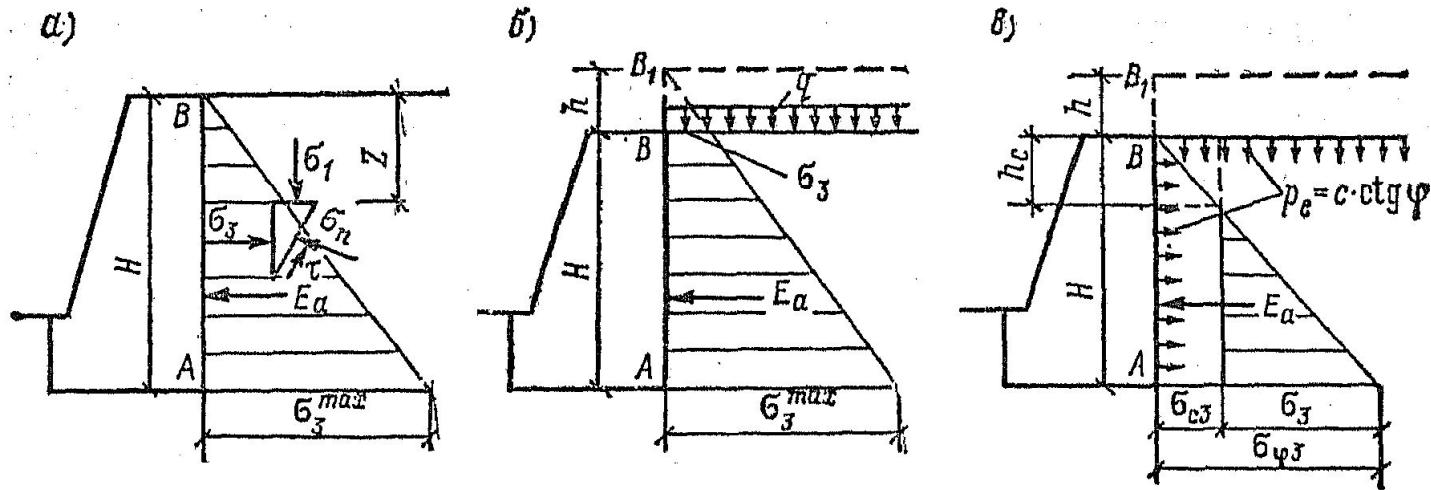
Схемы для определения давления грунта на гладкую подпорную стенку
